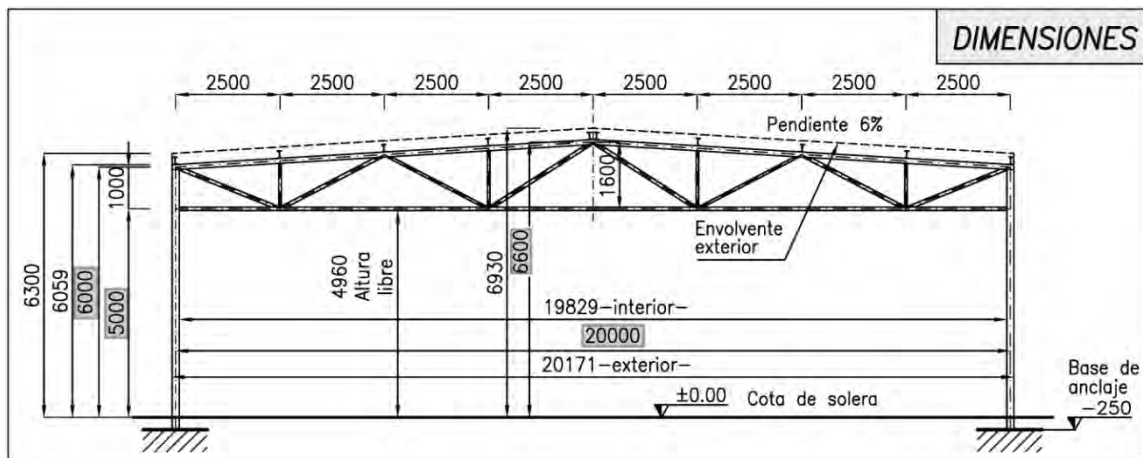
Tipología estructural y dimensiones que figuran en el plano de alzado (mm)
